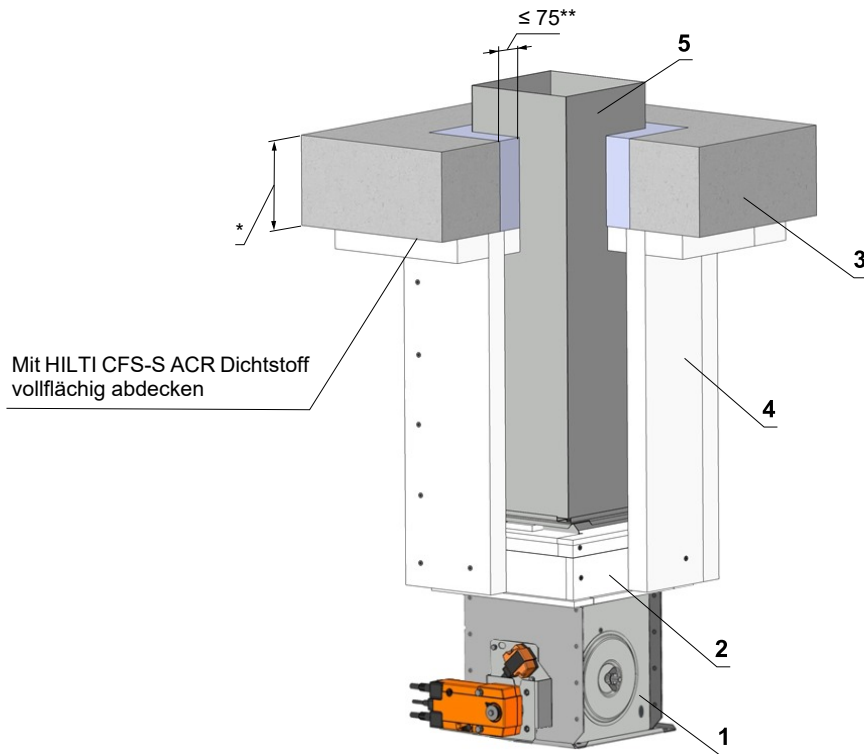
Außerhalb der massiven Deckenkonstruktion - Einbaurahmen E6 mit Isolierung mit Kalziumsilikatplatten
